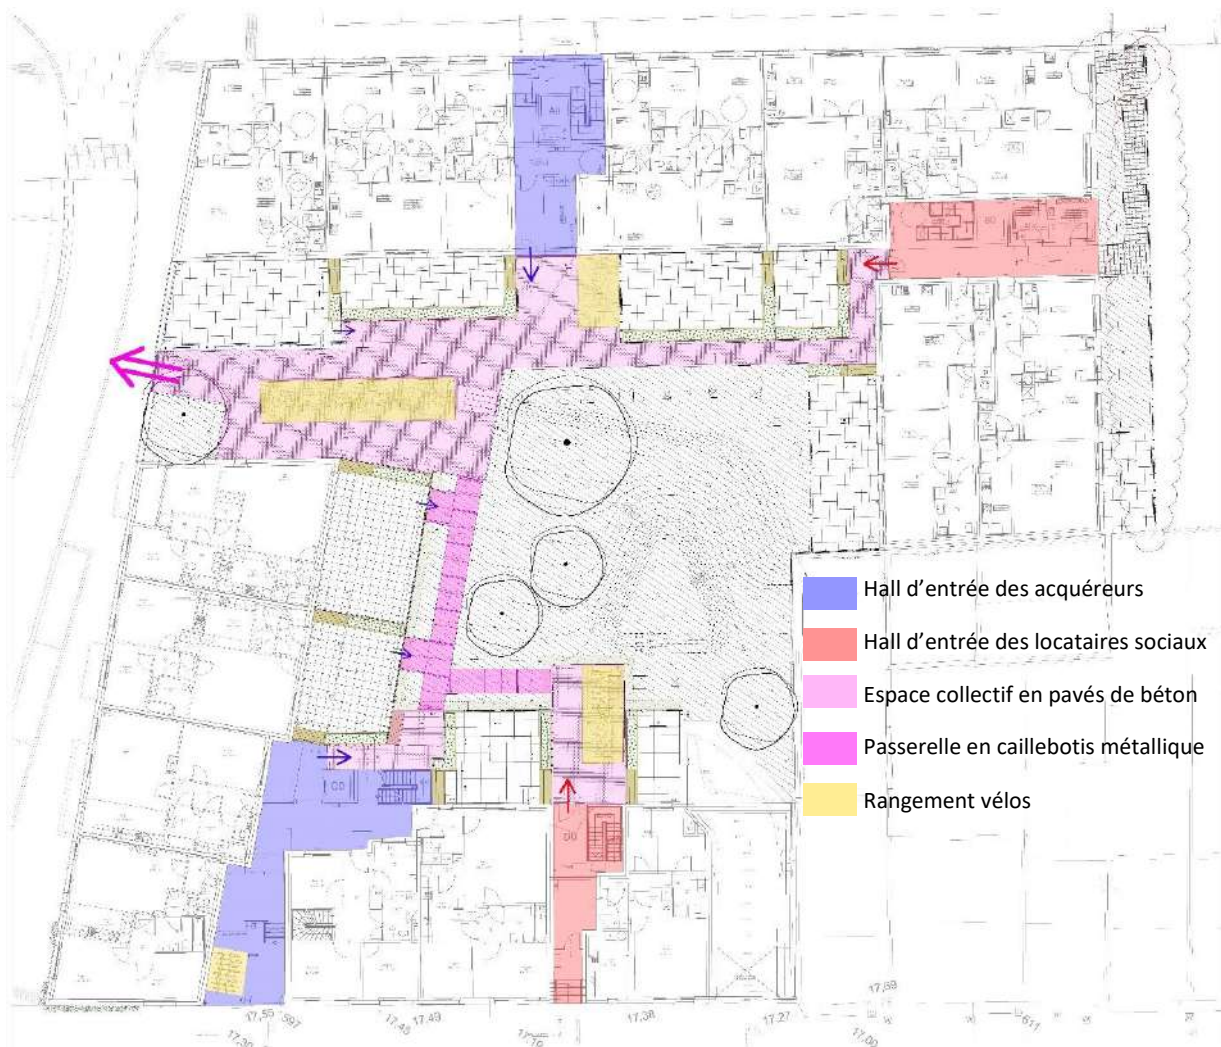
Plan de l'intérieur d'îlot du lot 7 (fond de plan issu de ADRIANA, annotations personnelles)
